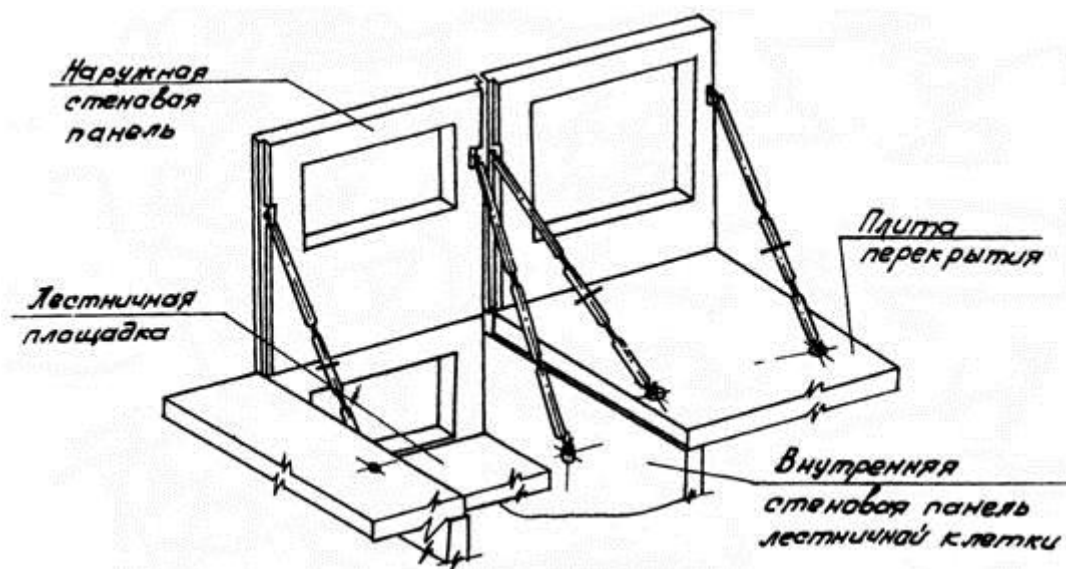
Временное крепление наружной стеновой панели, ограждающей лестничную клетку
